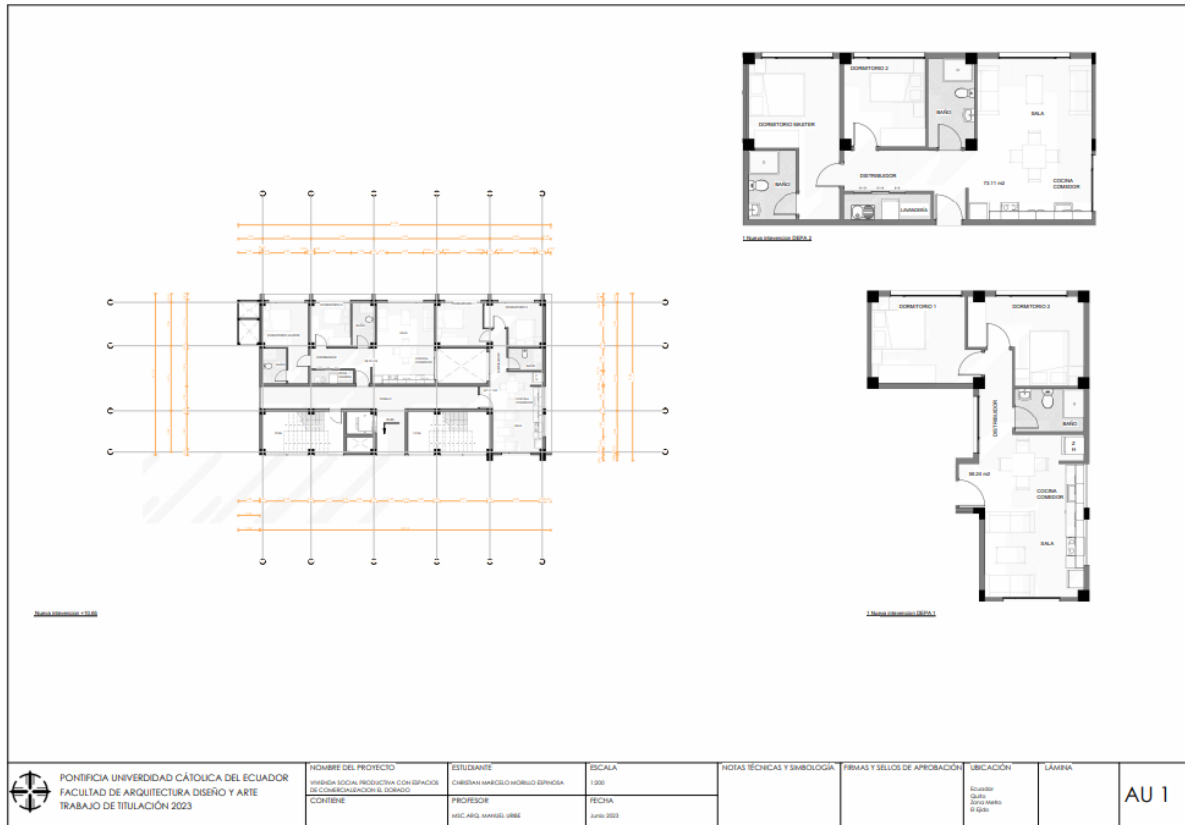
Primera y Segunda intervención- Planta Tipo 1 y 2. (Morillo C. 2023)
